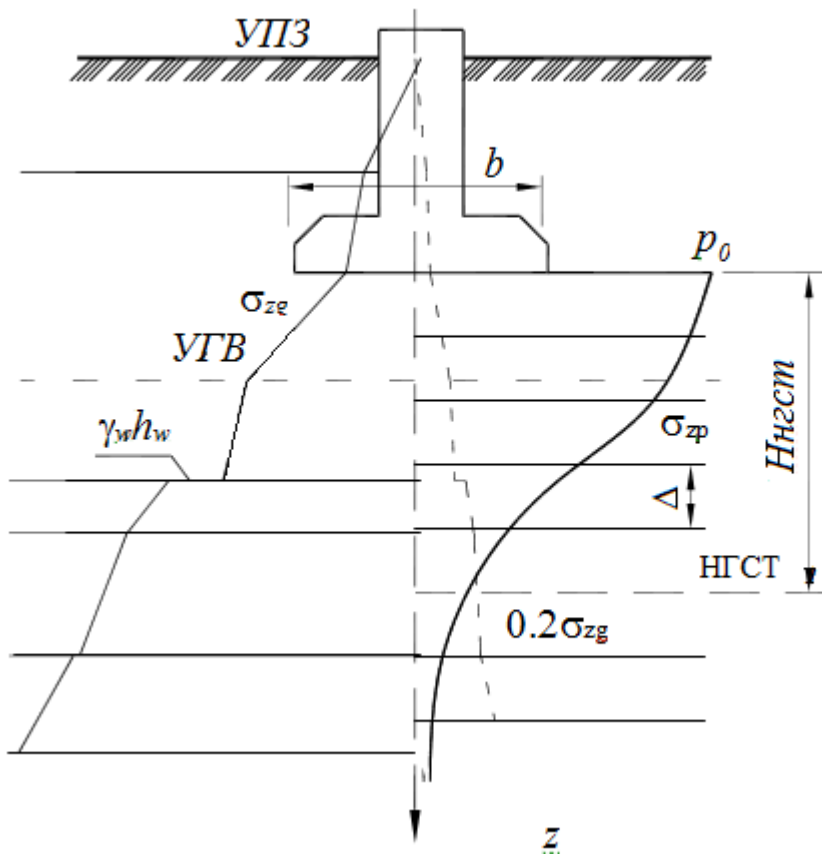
Схема к расчету напряжений в основании фундамента
